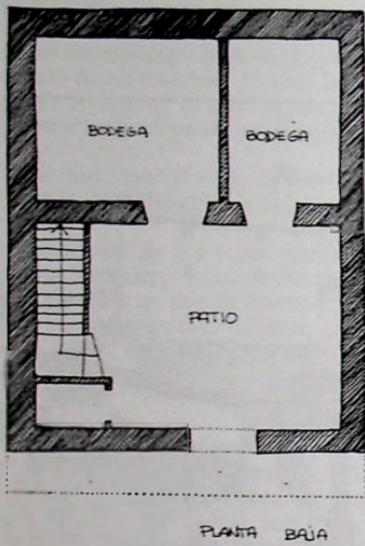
Planta de vivienda en un núcleo de La Vera.
